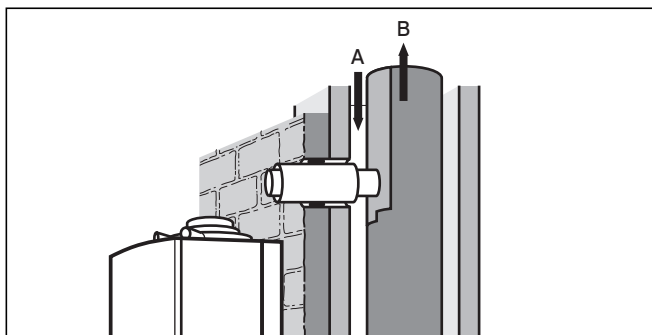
Укорачивание длины трубы газопровода и установка трубы воздухопровода
